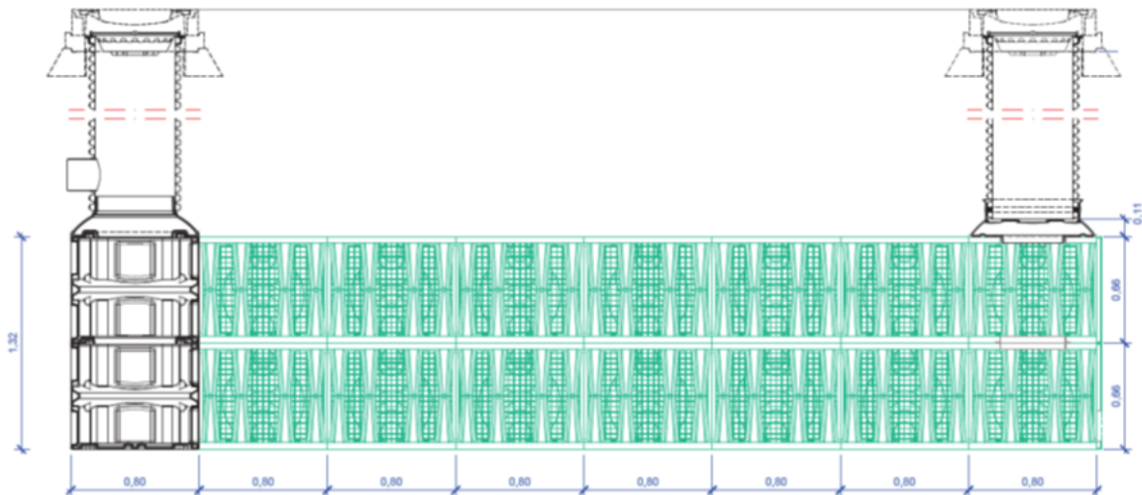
Vue de dessus d'un bassin réalisé en mix Rigofill inspect et ST-A avec boîte d'inspection intégrée
